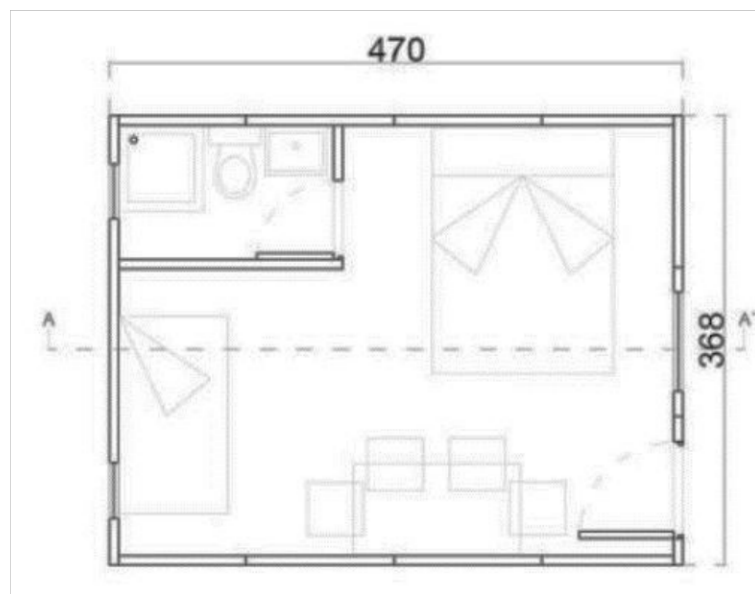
Planta arquitectónica. Tomada de <https://issuu.com/yurichamblas/docs/soluciones-constructiva-saplicadas>
